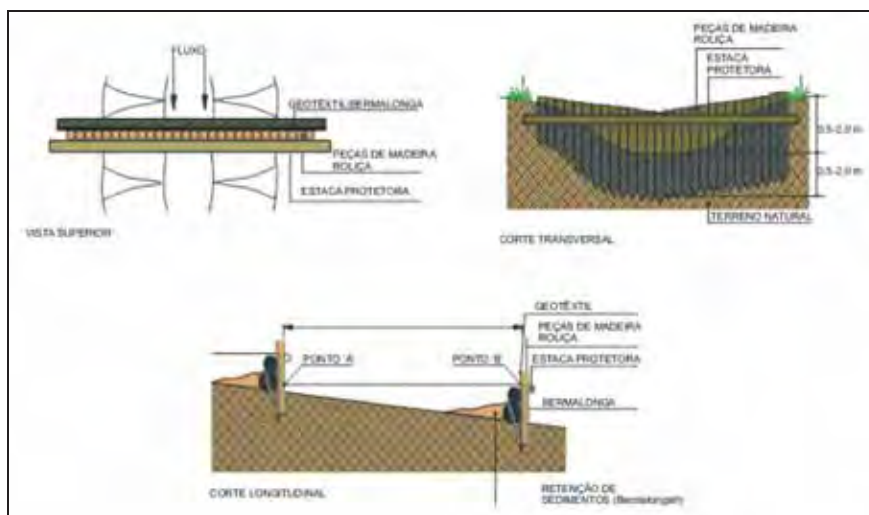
Vista em planta e corte da construção de paliçada de madeira (Fonte: Pereira, 1998 citado por Couto et al., 2010).
